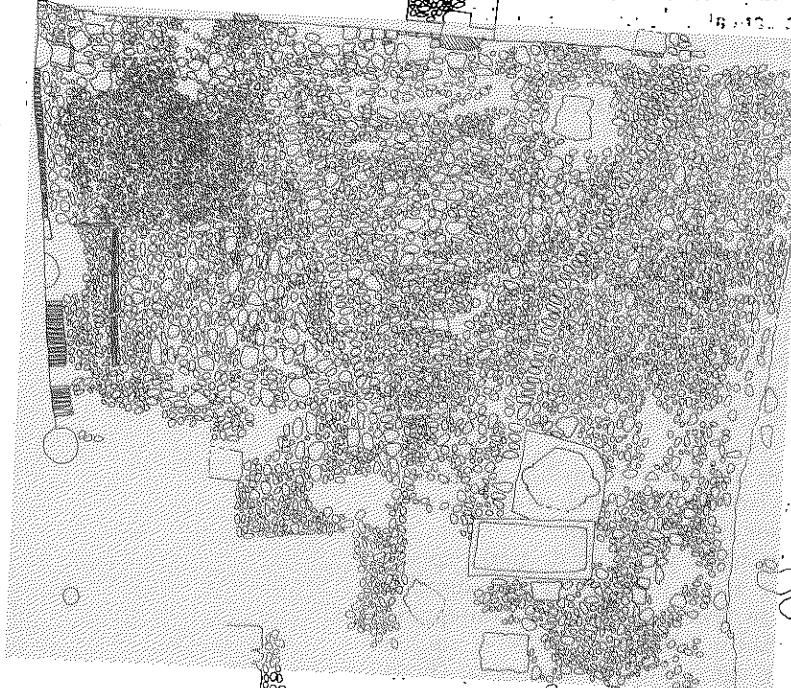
Planta con patio empedrado y catas C-1, C-2, C-3 y C-4.
